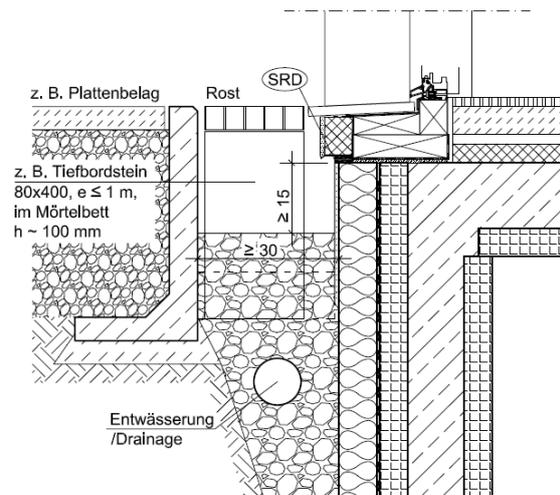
Terrasse mit Fenstertüre und Putzfassade
